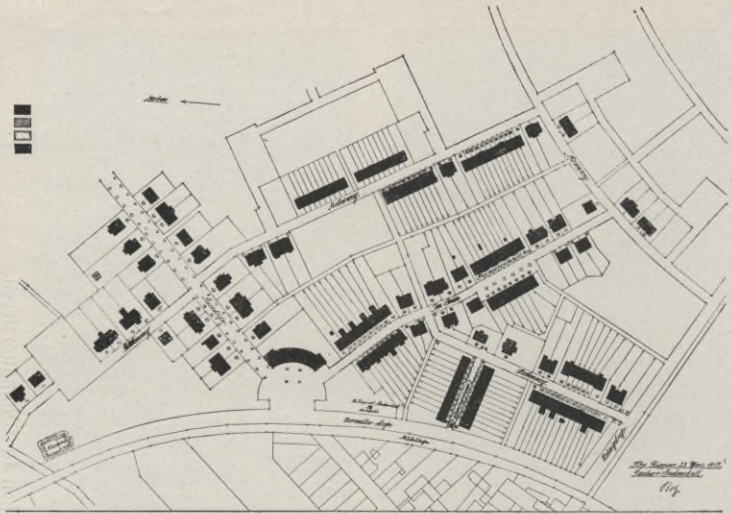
Plan der Gartenstadt Karlsruhe (Architekt Bolz).
